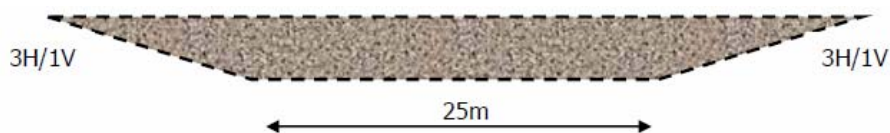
profil en travers du reprofilage du lit (source : étude d'impact).
